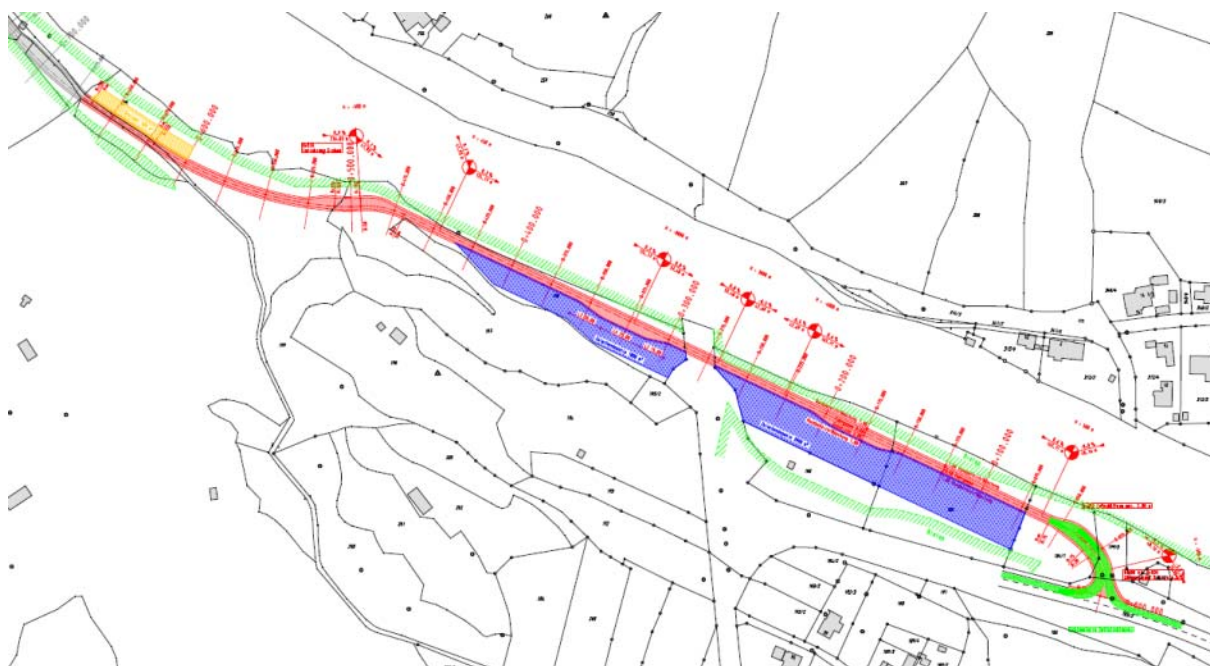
Übersichtslageplan temporäre Bauzufahrt Krafthaus Baustelle
